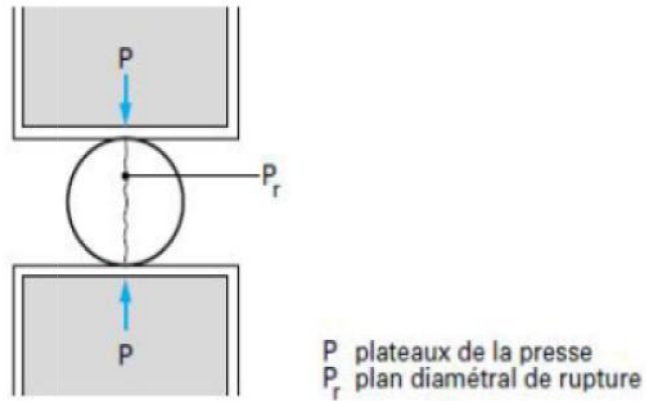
Essai de fendage sur éprouvette cylindrique
